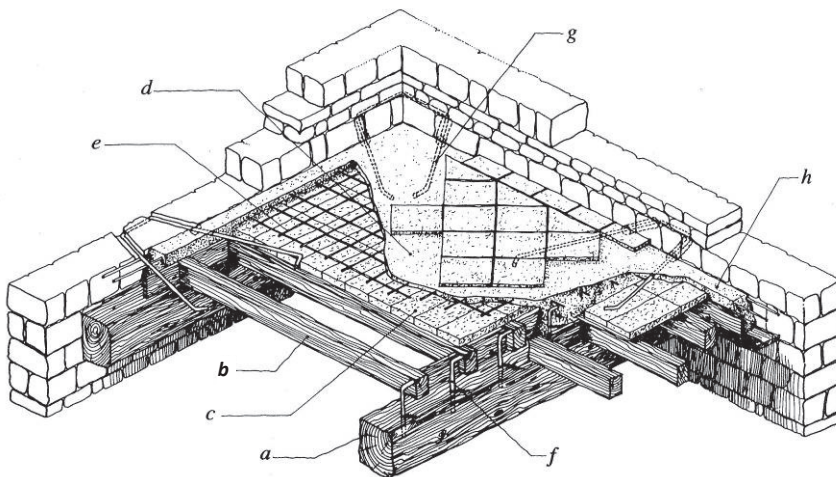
Beispiel einer Holz-Beton-Verbunddecke in einem erdbebengefährdeten Mauerwerksbau. (a) Hauptträger, (b) Nebenträger, (c) Ziegelplatten, (d) Betonplatte, (e) Bewehrung, (f) Stabdübel mit Epoxidharz ins Holz eingeklebt, (g) Stählerne Anker zur Verbindung von Mauerwerk und Betonplatte, (h) Ringbalken aus Stahlbeton. (STEP 1995 Beitrag E13)
